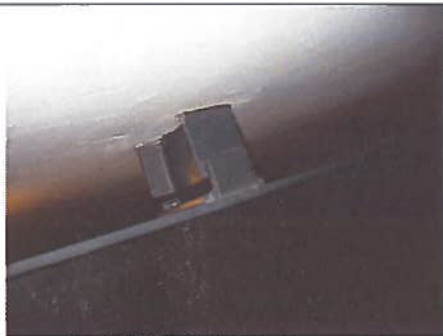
[REDACTED] Staalconstructie trappenhuis. De stalen oplegging van de bordessen heeft controle op de constructieve sterkte
